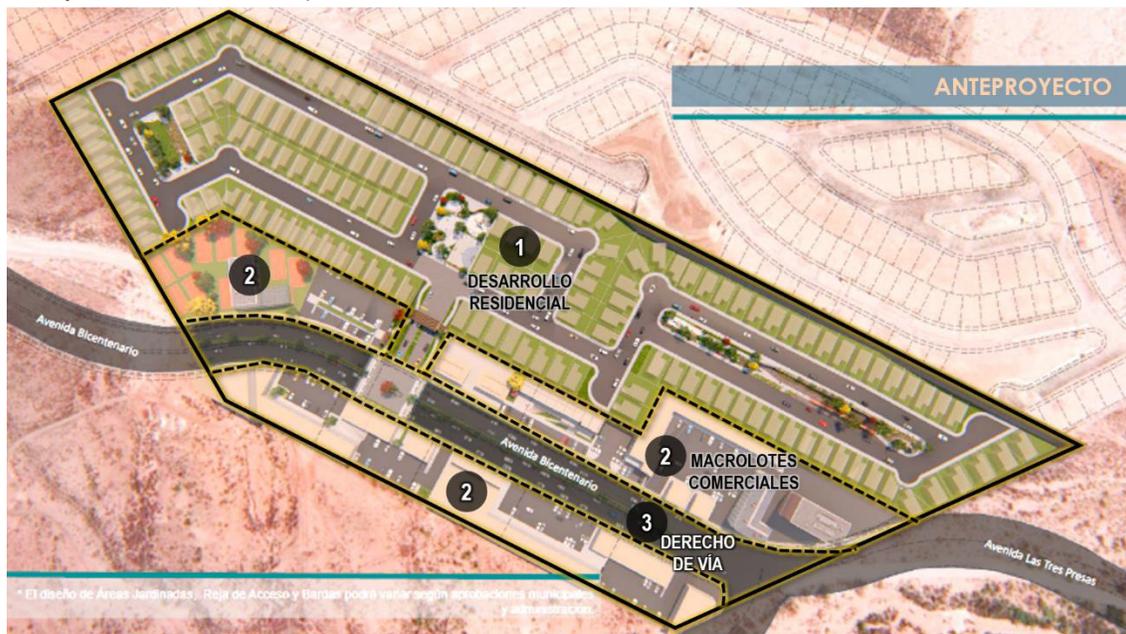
Anteproyecto Laderas del Rejón (anteproyecto sujeto a proyecto ejecutivo y a las modificaciones pertinentes).
